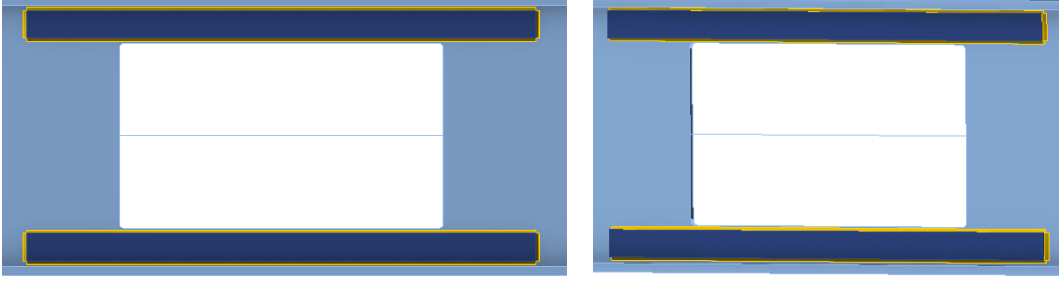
Tesisat boşluğu yatay rijitlik levhası kullanılarak takviye edilmiş kiriş (Model 3)
